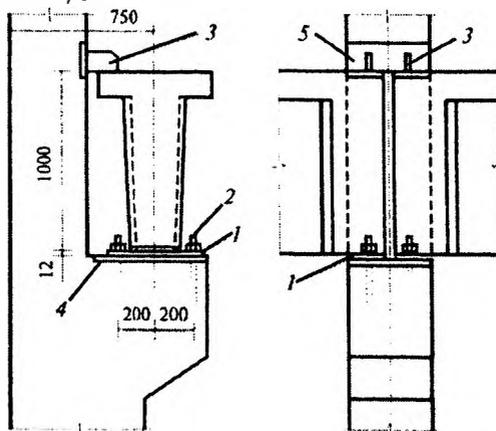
Крепление железобетонных подкрановых балок к колоннам.
